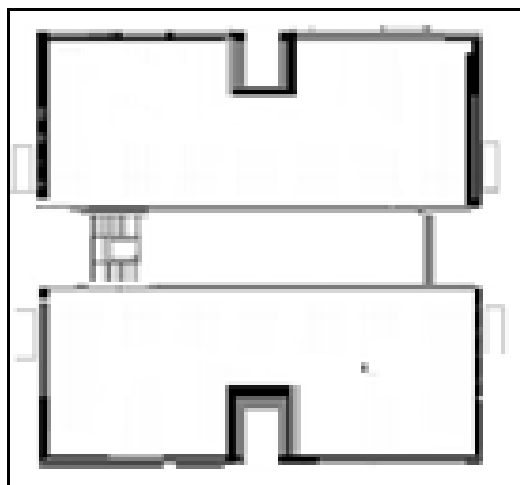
Půdorys PS 69/2 podtyp 3[vlastní zpracování].
